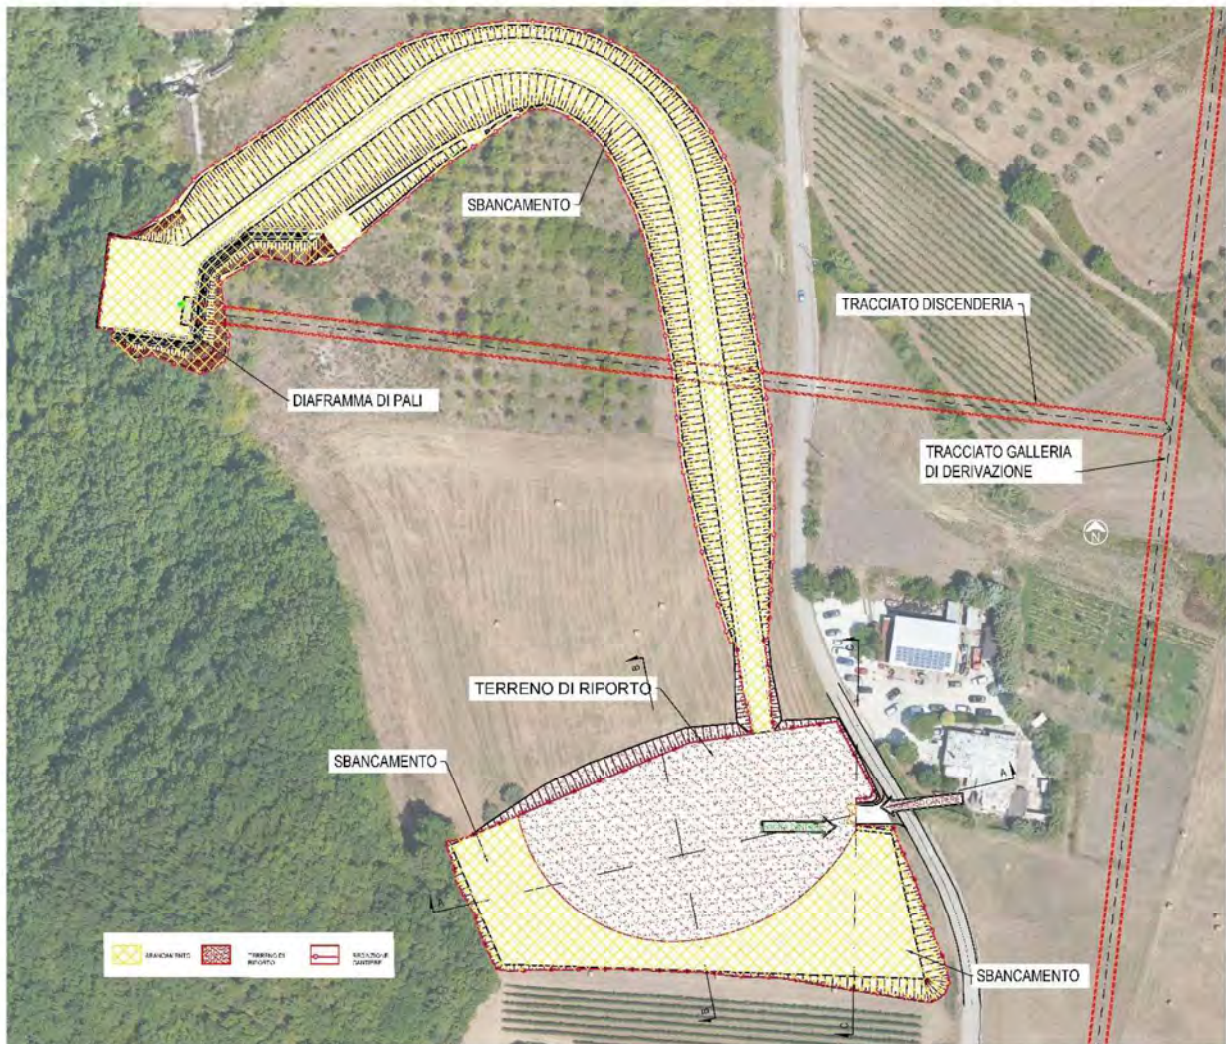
Pianta area di cantiere opere preliminari – Discenderia laterale.
